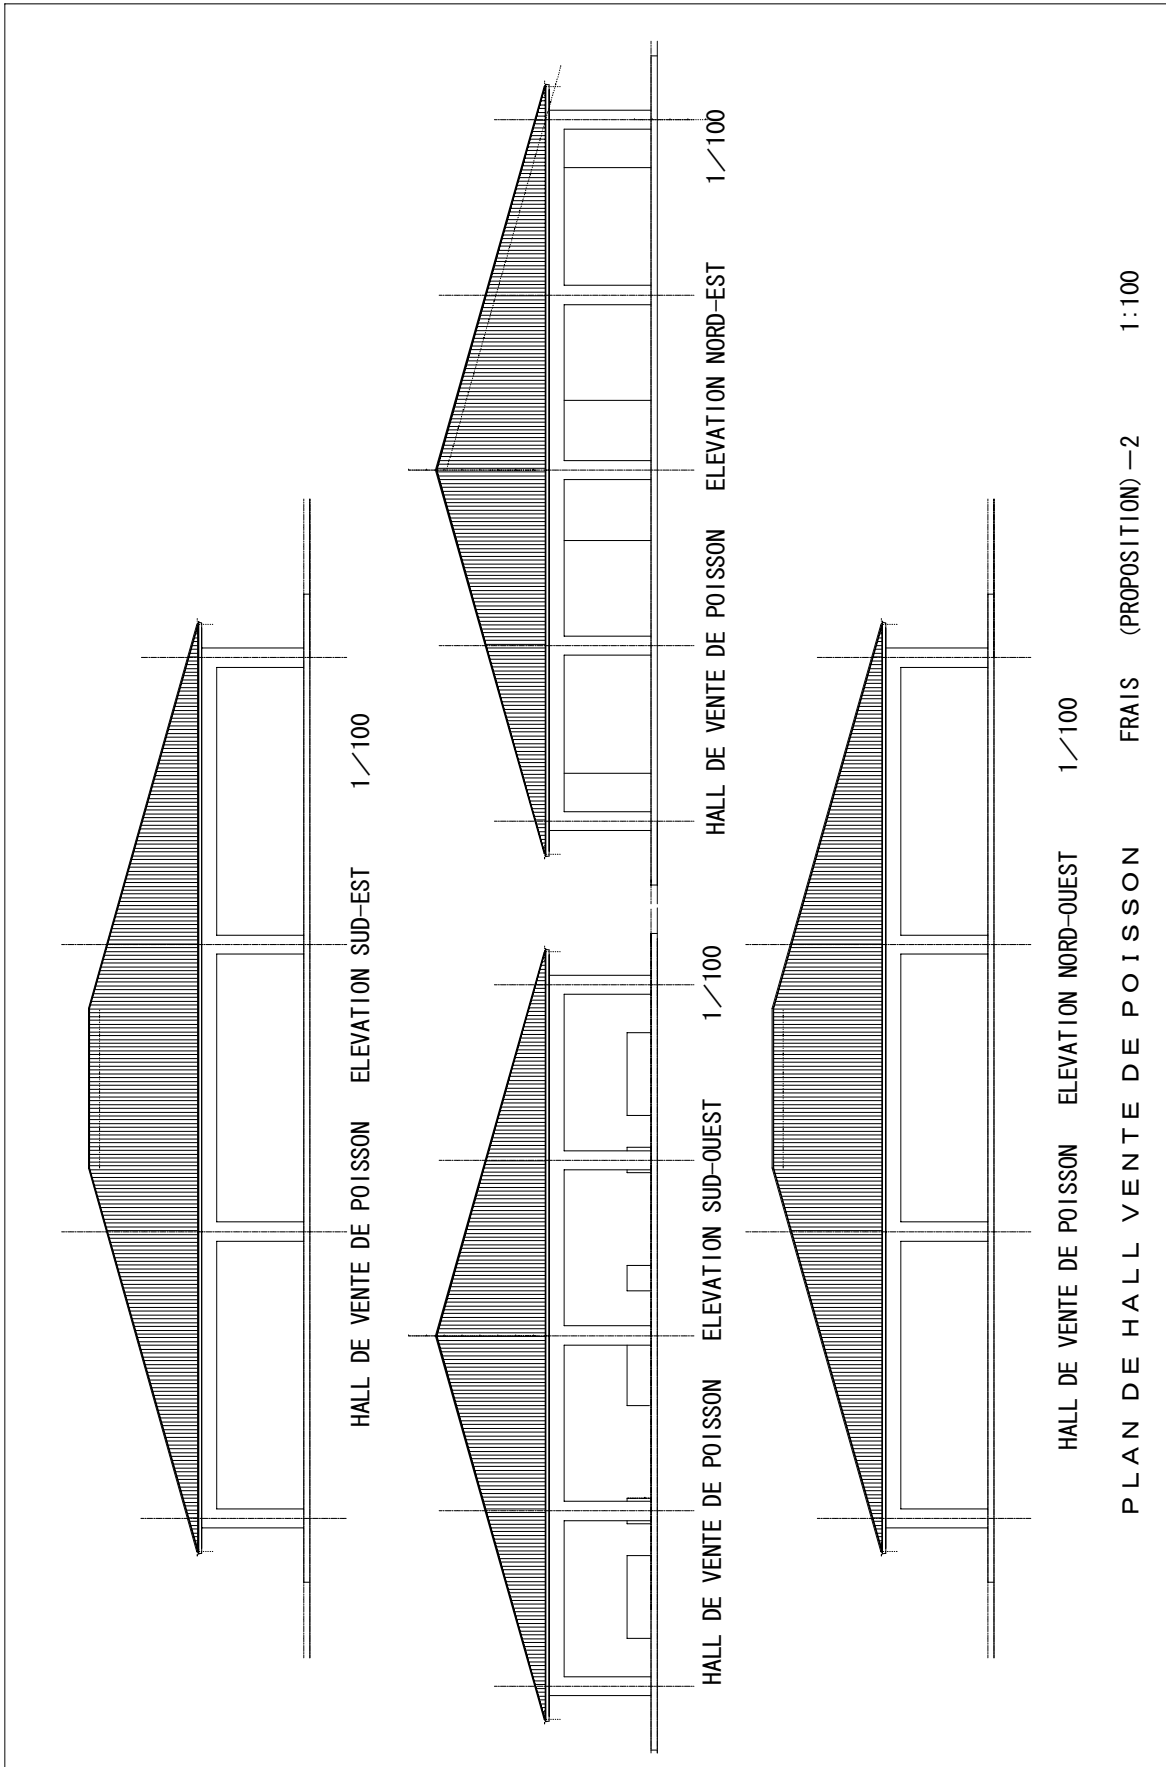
Plan du hall de vente de poisson frais (proposition) 2
